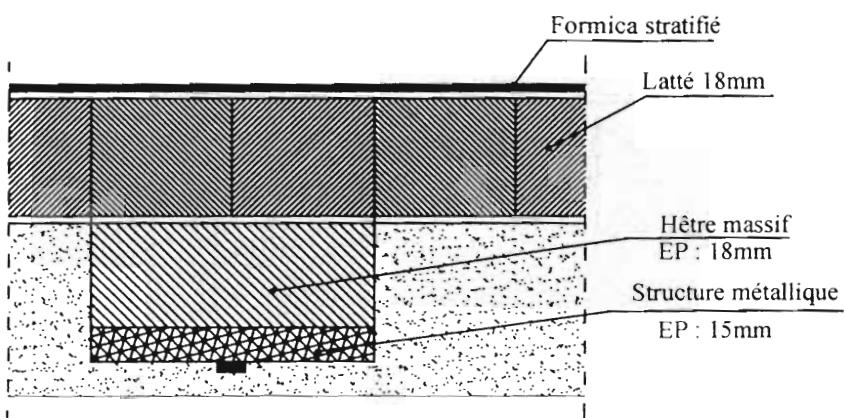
DETAIL DE LA PLANCHE DE TRAVAIL OU TOP
